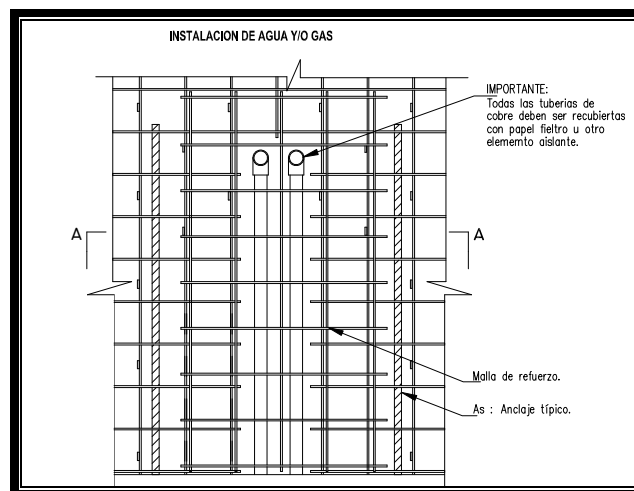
Detalle de Instalación hidráulica sobre muro estructural (Elevación)
